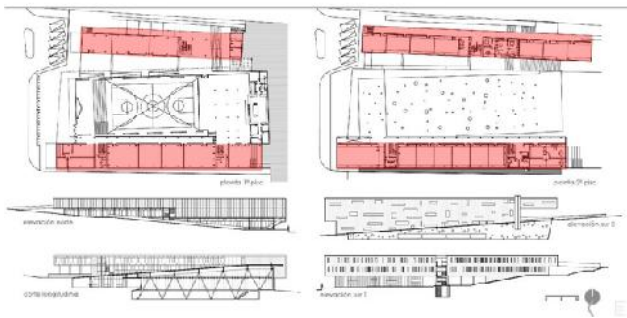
Planta y Cortes Colegio Altamira – Emplazamiento lateral de edificios para generar espacio público central. Esquema propia autoría.
